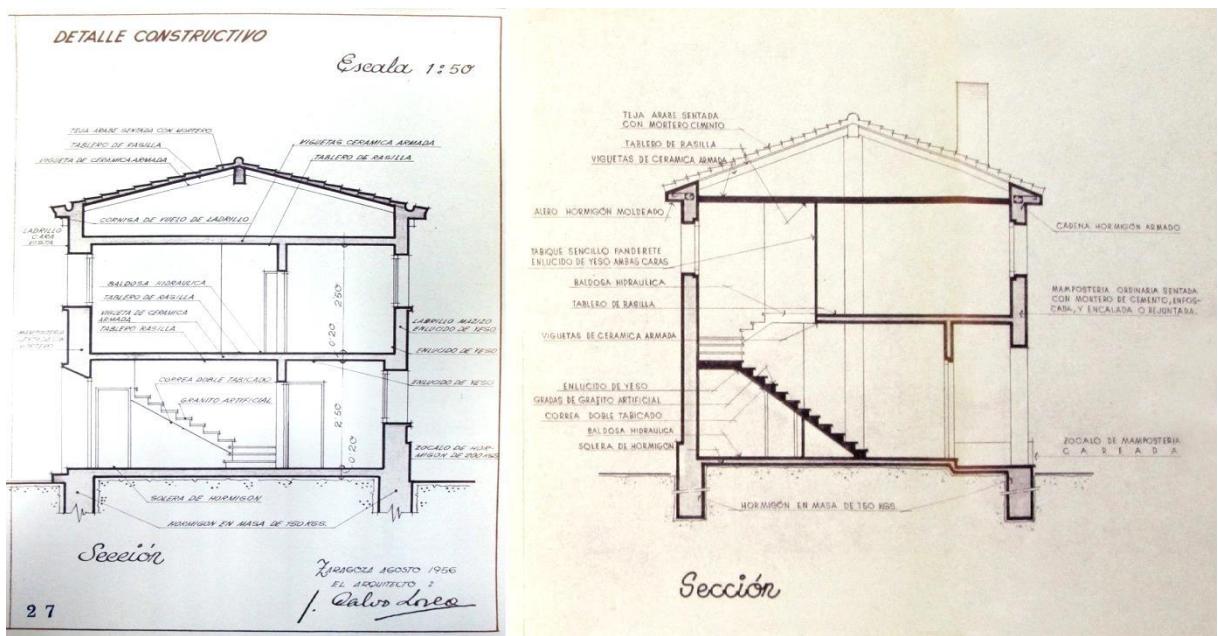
Secciones representativas de viviendas en Curbé y Sodeto respectivamente. Fuente: ACMA
